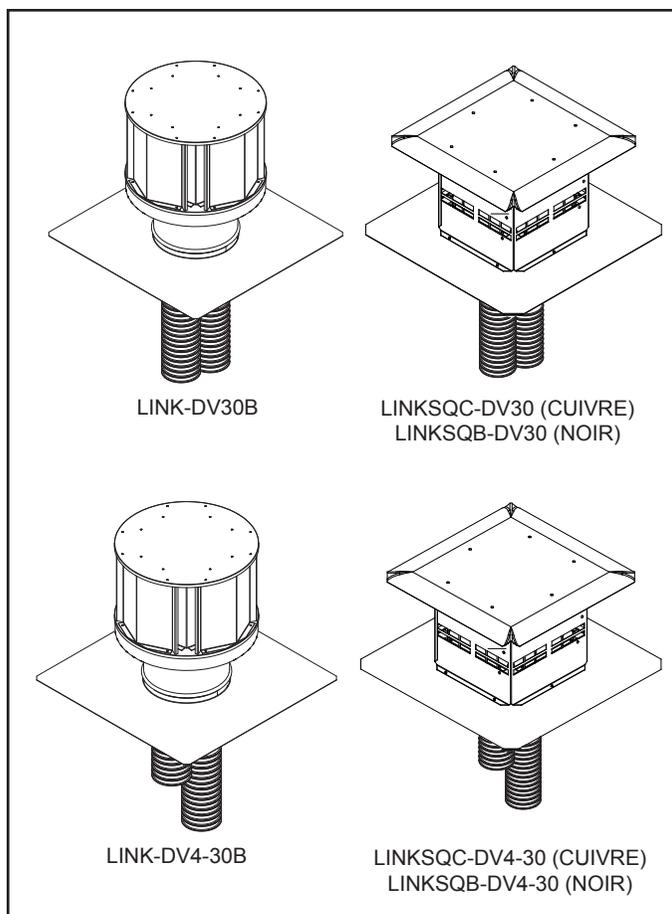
Ensembles de doublage de conduit flexible d'évacuation directe
